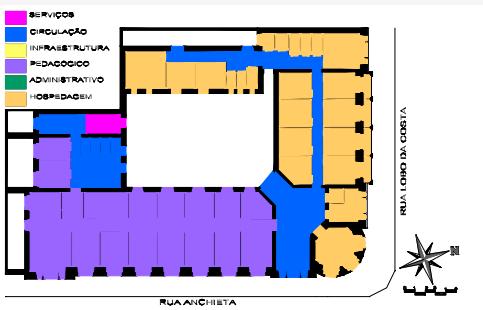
Zoneamento / Planta Baixa 3º Pav.
